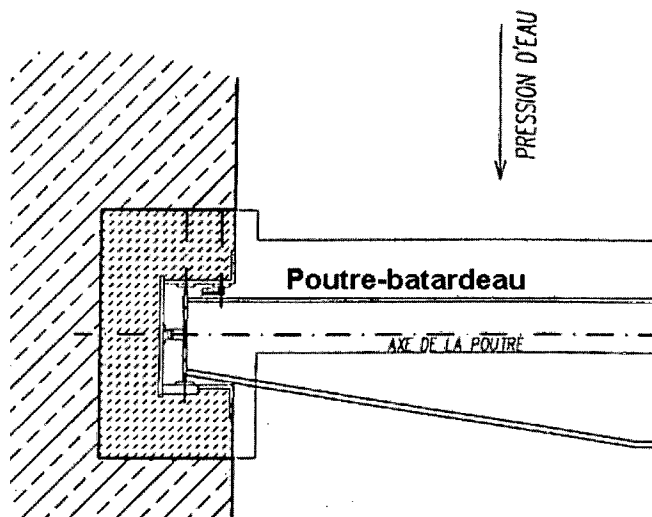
Barrage à poutrelles (Vue du dessus)
